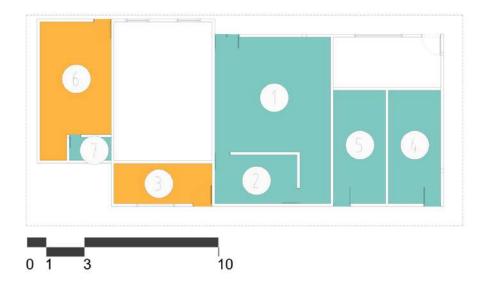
Planta 1 Bloque 39. Fuente: Equipo de diagnóstico.
